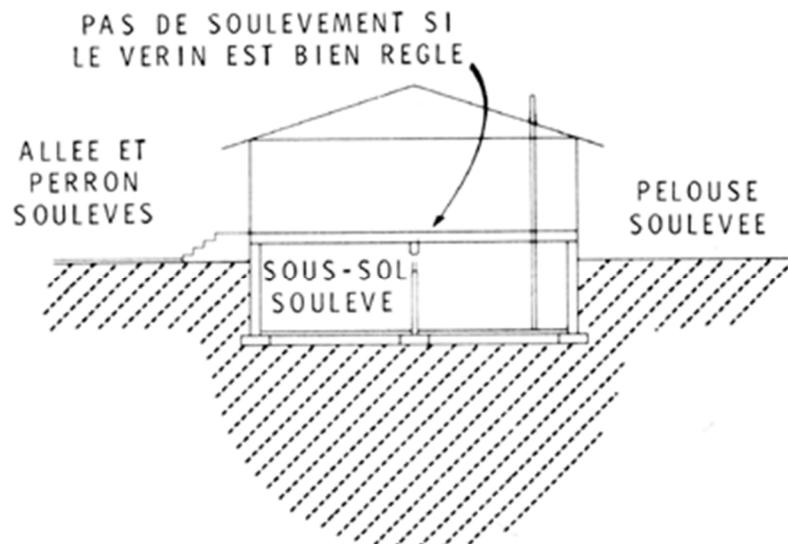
Rendement à court terme typique d'une fondation peu profonde construite sur un dépôt profond de sous-sol gonflable.
